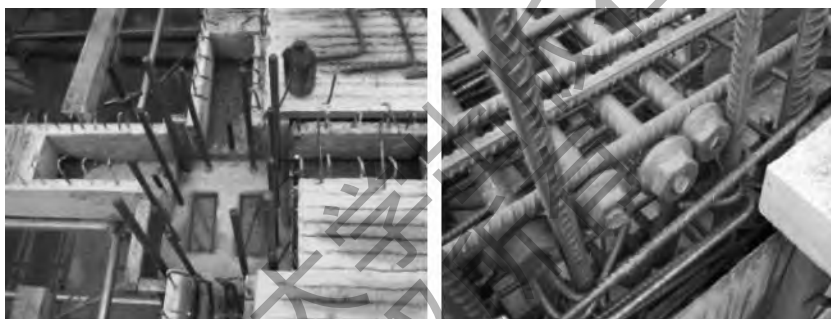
预制梁柱节点现场钢筋连接锚固板示意
